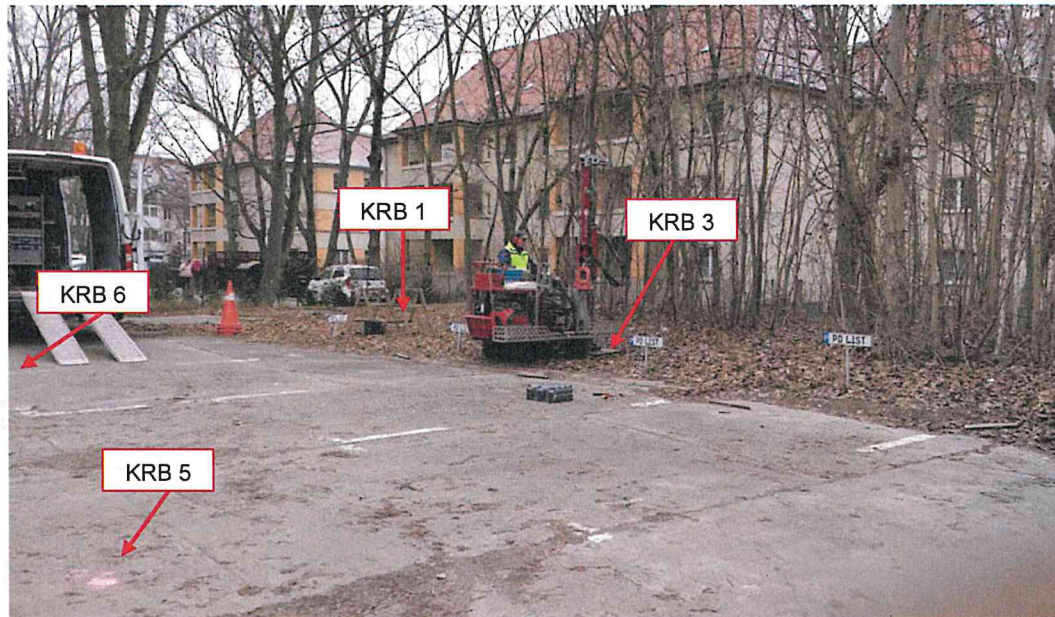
Blick Richtung Südwesten. Im Vordergrund: Parkplatzfläche mit Bohransatzpunkten KRB 5 und 6. Im Hintergrund: unversiegelter, bewachsener Bereich mit Bohransatzpunkten KRB 1 - 3.
